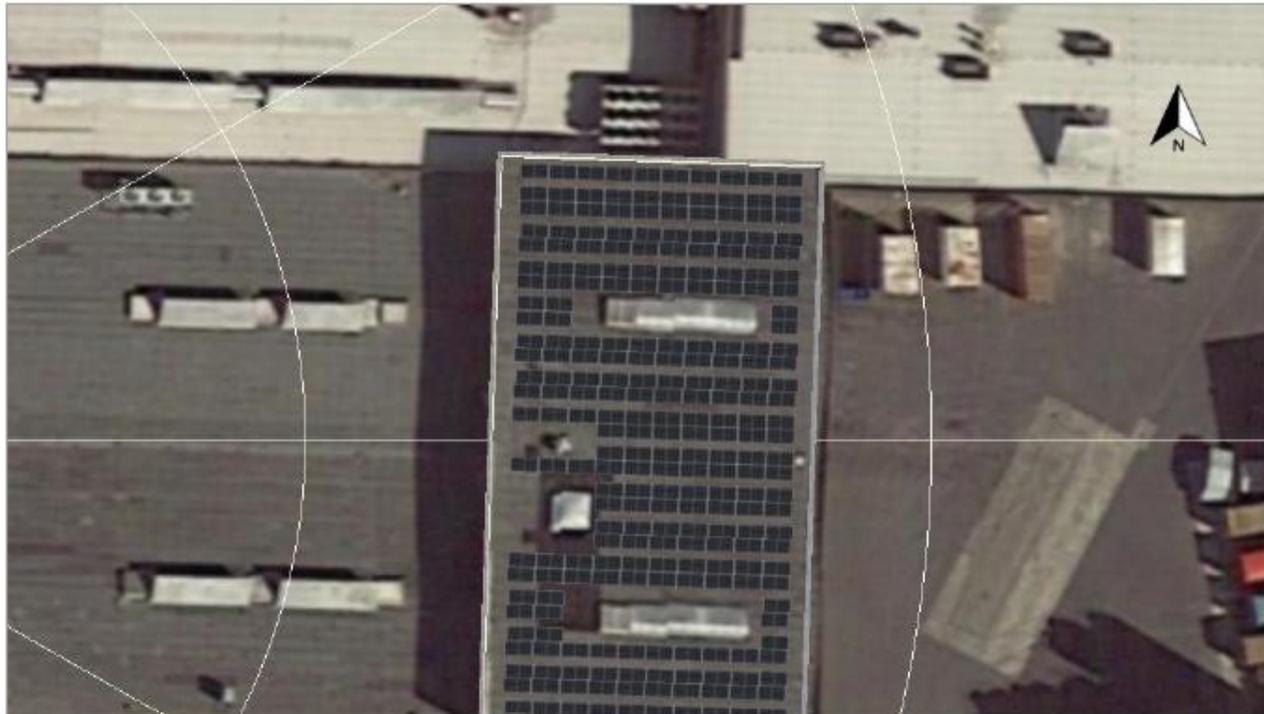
Modulfläche - Gebäude 02-Dachfläche Süd
